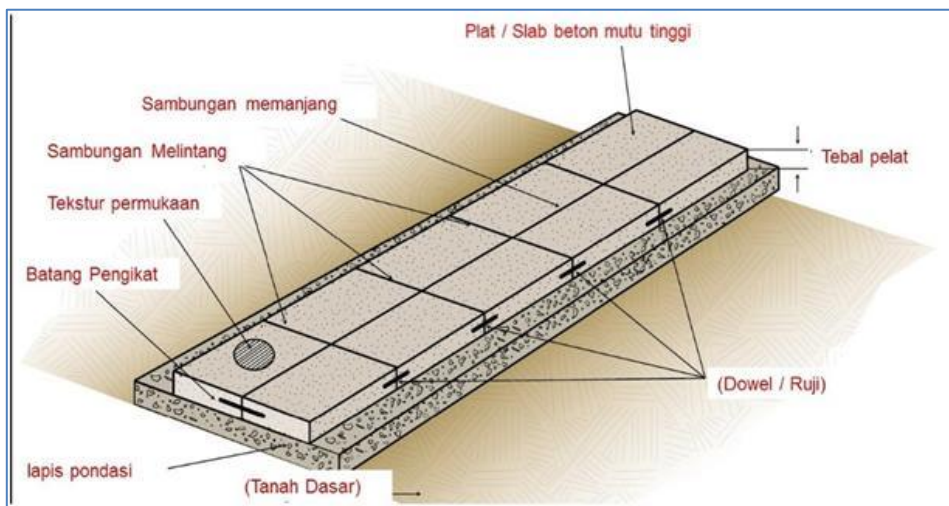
Tipikal bahu beton pada perkeasan kaku
